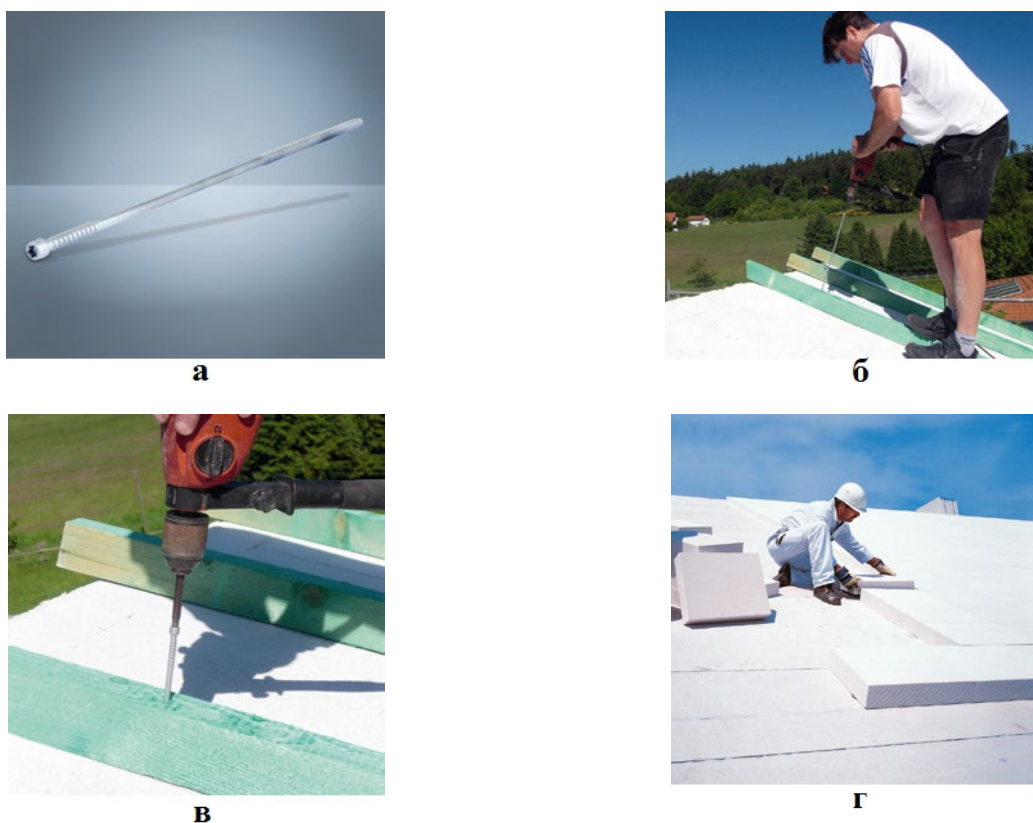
Монтаж изоляции скатной кровли Multipor DAD: а — кровельный шуруп Ytong для закрепления несущей обрешетки; б — завинчивание кровельного шурупа на комбинированной кровле; в — полное закручивание кровельного шурупа в несущую обрешетку; г — плита Multipor DAD на кровле
